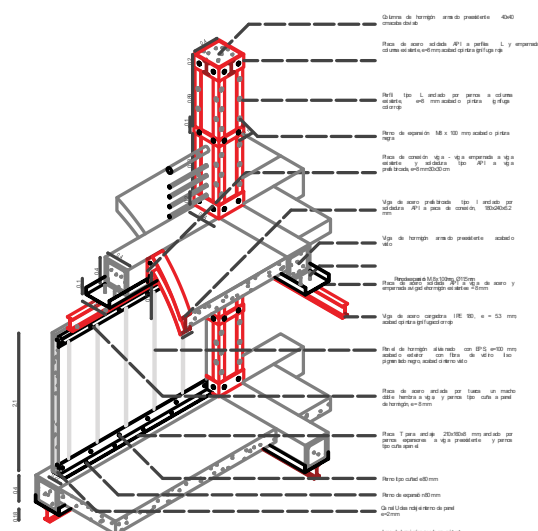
Detalle de refuerzo estructural, 2024, Quito. Elaboración propia.
